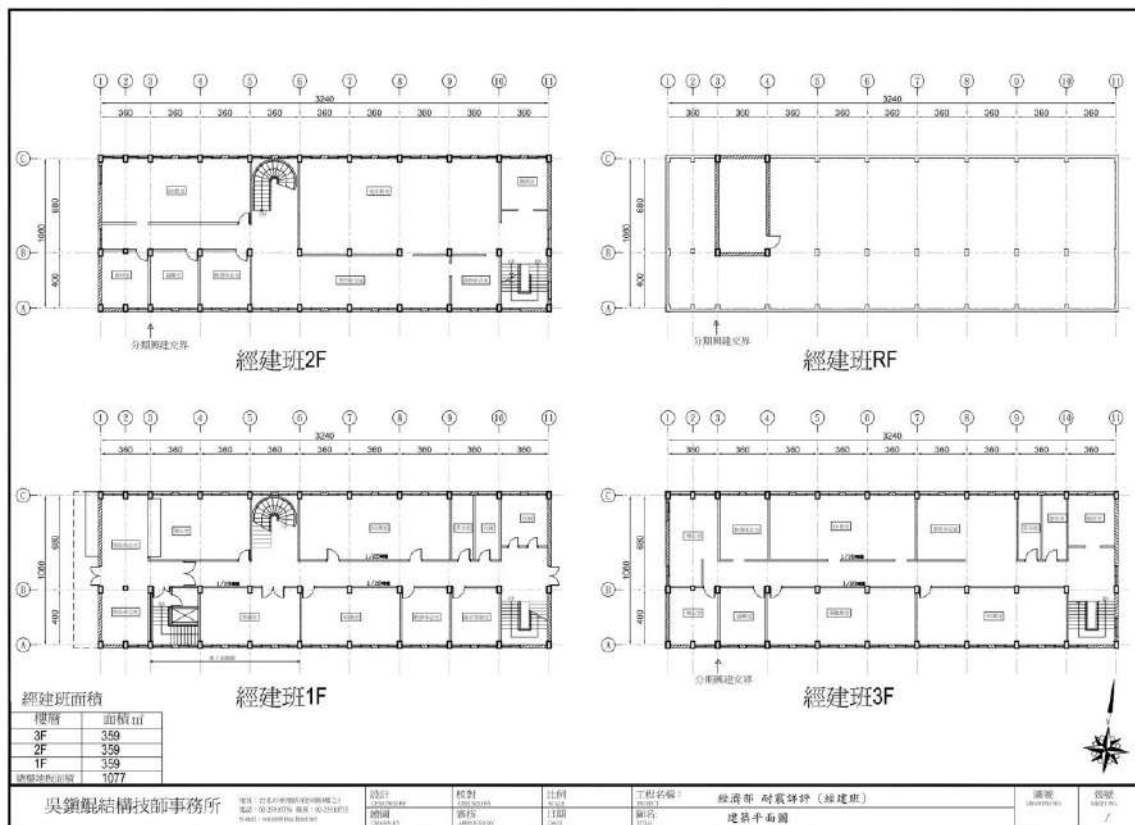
部本部經建班 1 層至屋頂層平面圖
